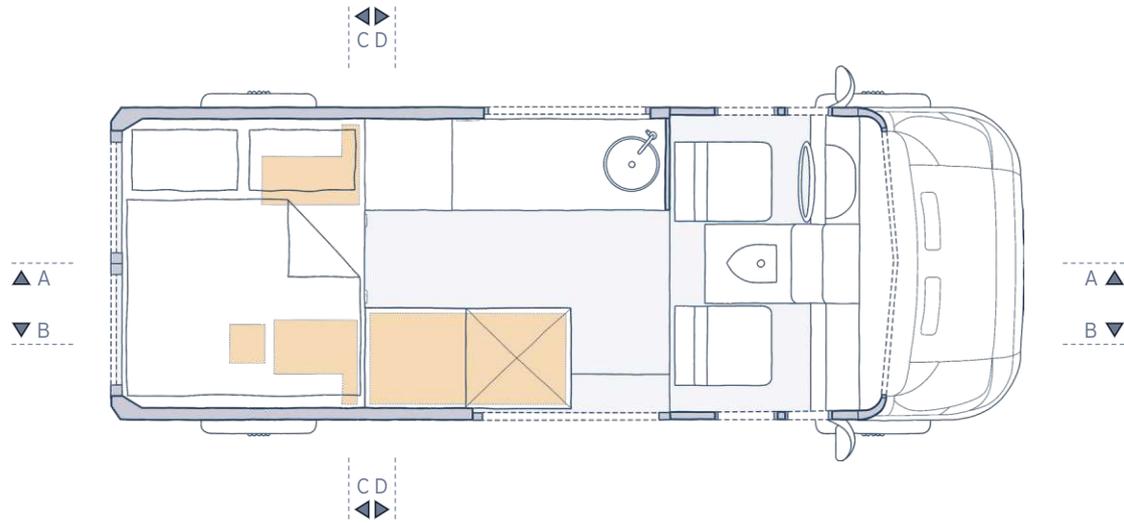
Campervan für eine Person - Wasserversorgung und Stromversorgung - Grundriss (Maßstab 1:50)
